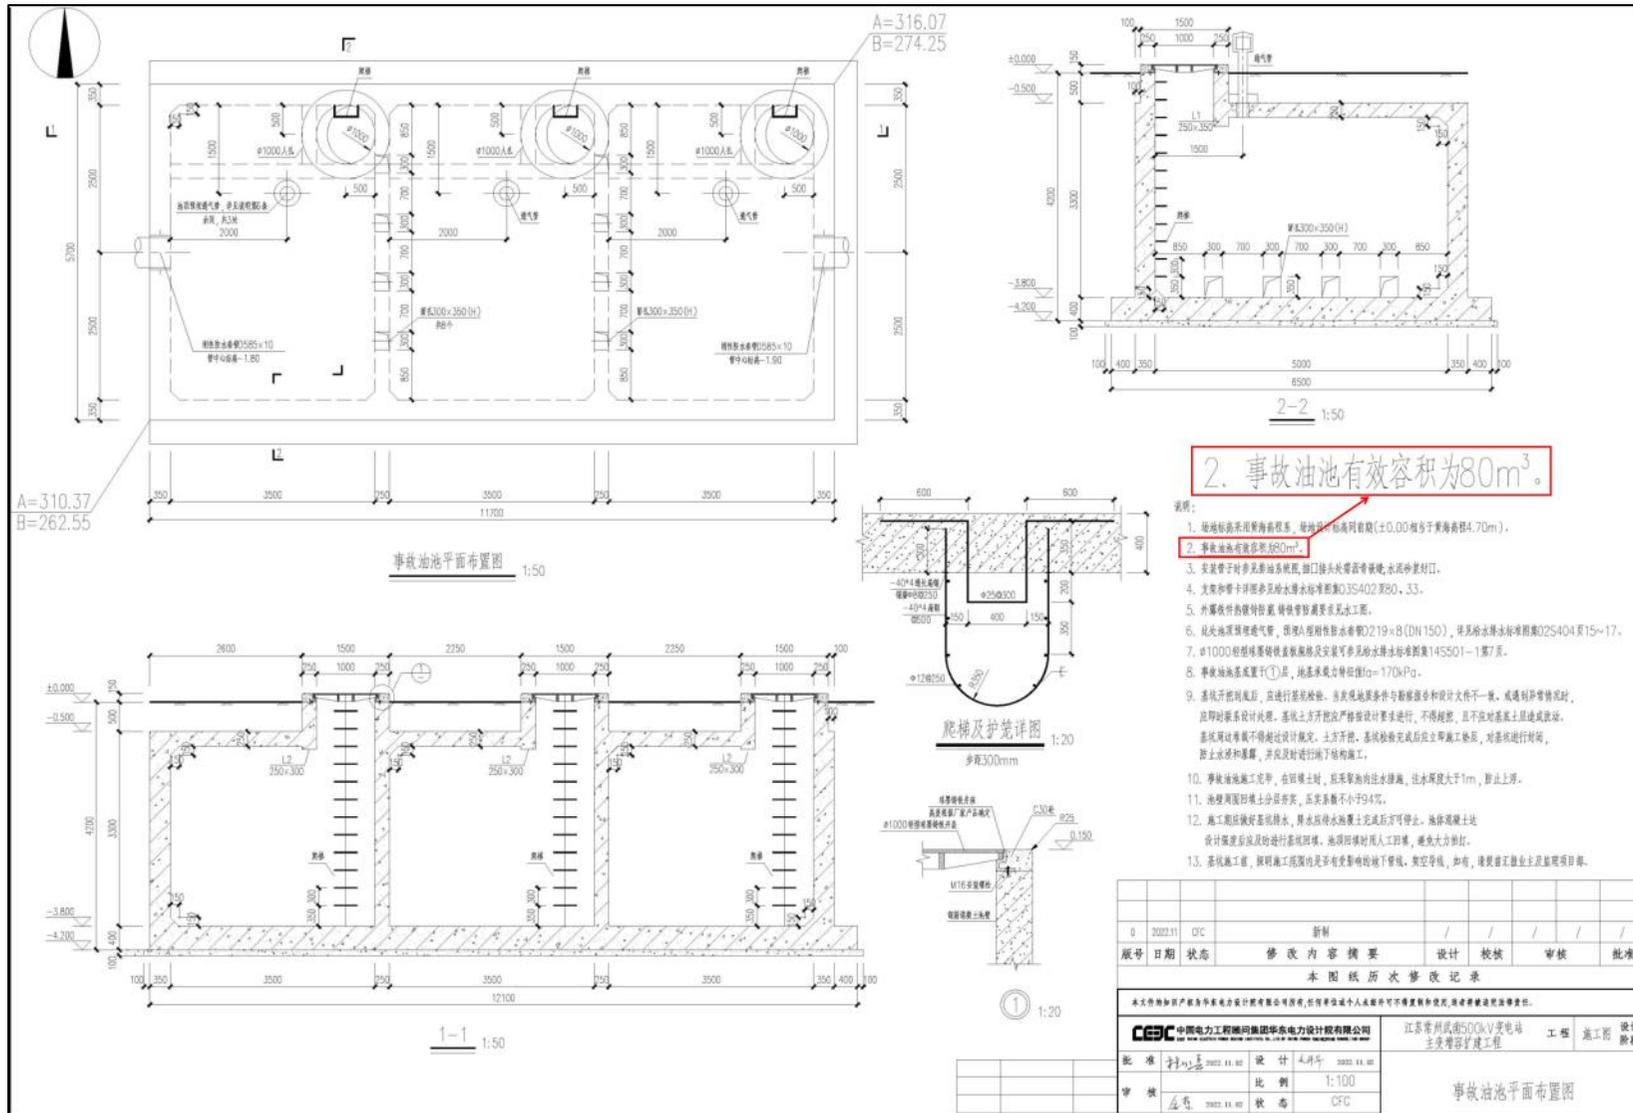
本项目 500kV 武南变电站主变区事故油池平面布置图
